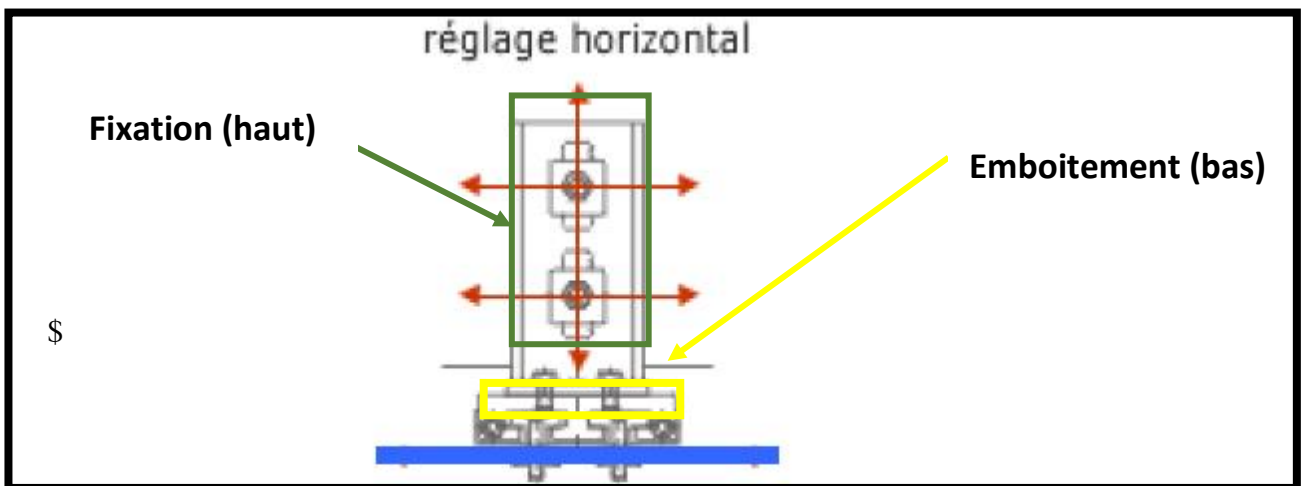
vue en plan du système de fixation des murs-rideau monté en panneau
